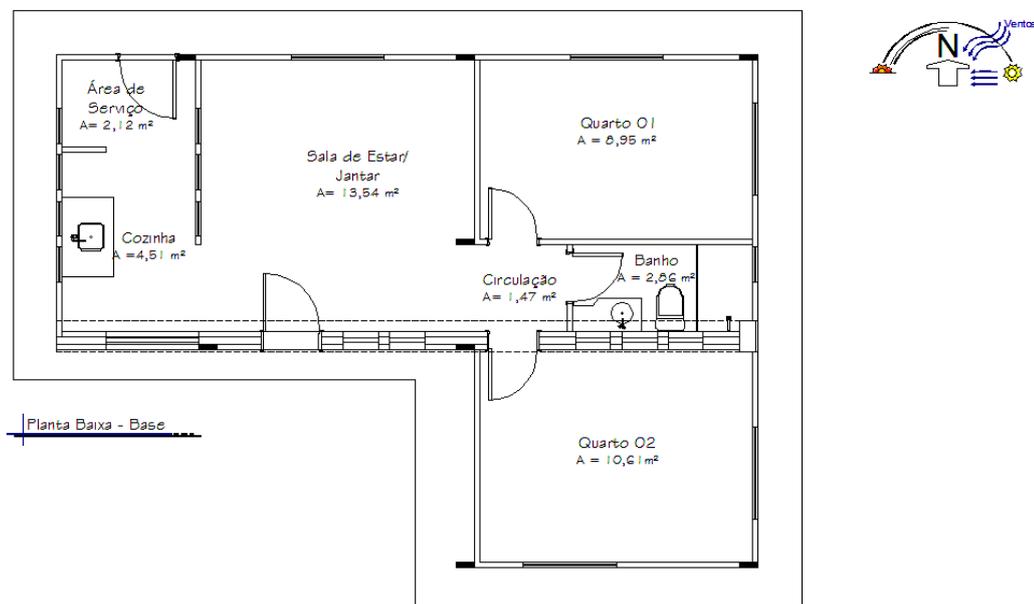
Proposta Projeto Modelo de Habitação - Planta Baixa Base.
